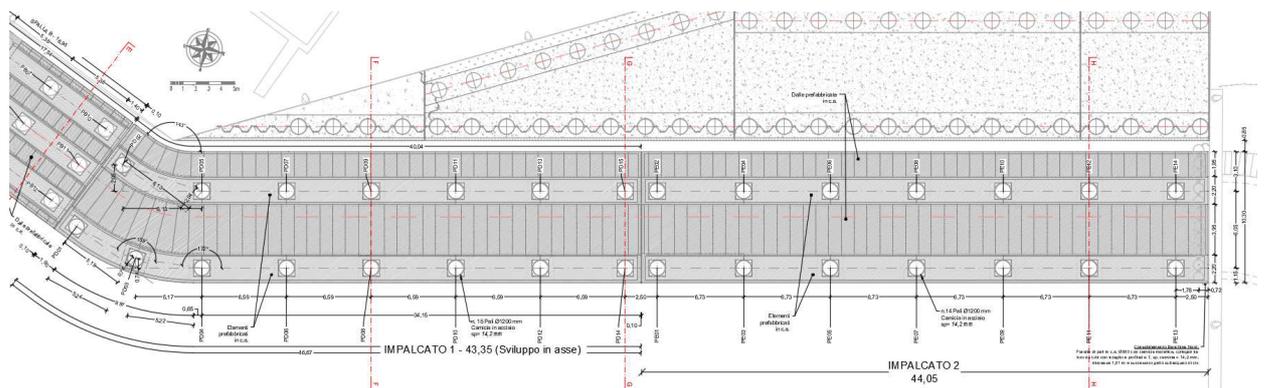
Planimetria della viabilità su pali (Impalcato 1 e 2)
